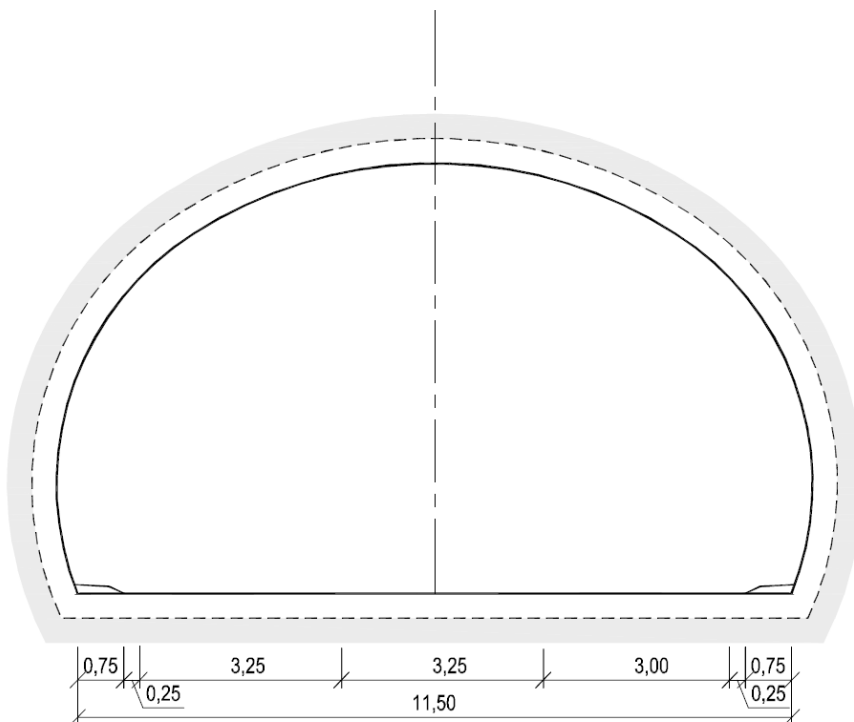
Tunnelprofil T8,5 (mål i m).
